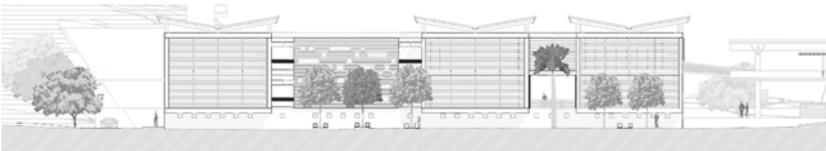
Edificio Q y Q – fachada 1 - anteproyecto - diciembre 2009
